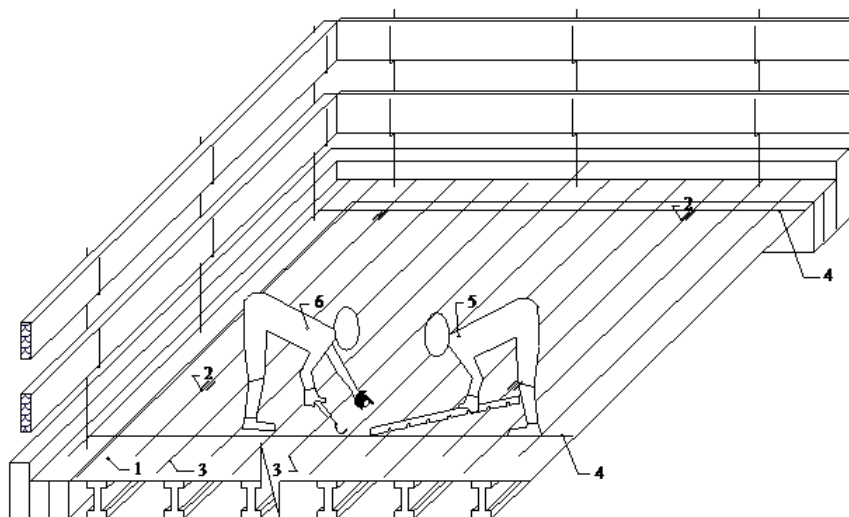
Разбивка палубы при устройстве нижней арматурной сетки: 1 – несущая стена; 2 – инвентарное ограждение; 3 – палуба опалубки перекрытия; 4 – рулетка; 5 – вынесенные на палубу разбивочные оси
